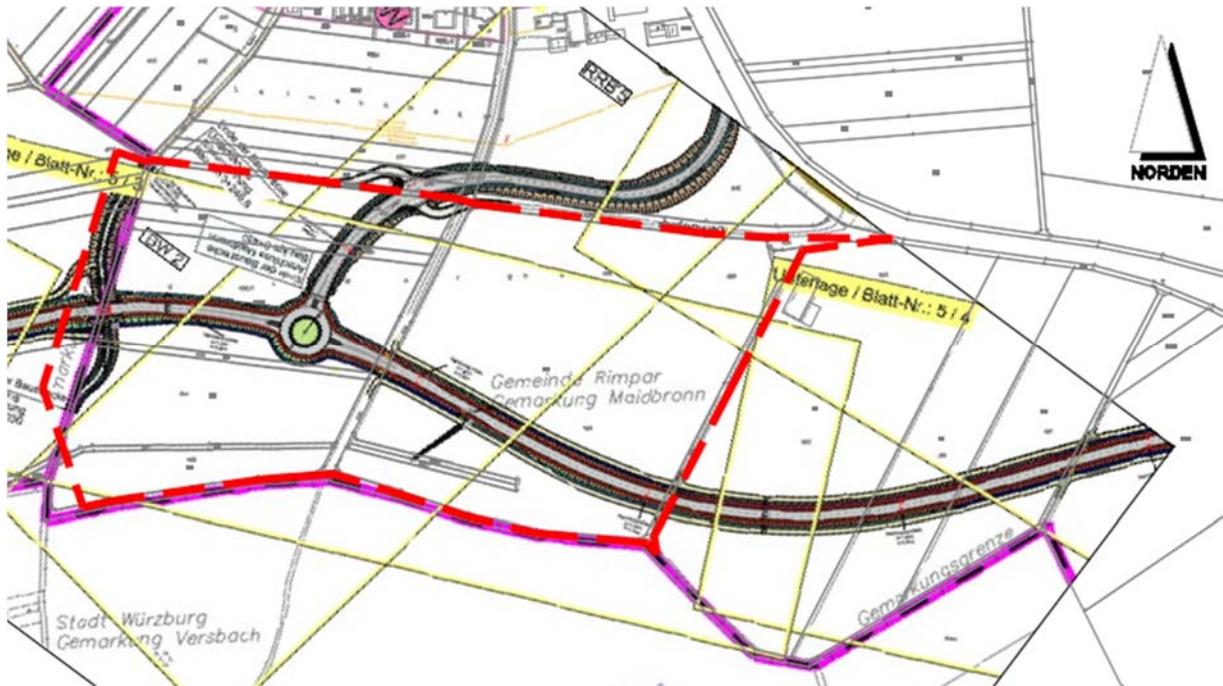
Auszug Übersichtslageplan Vorentwurf Ingenieurgesellschaft Maier Neubau Südumfahrung mit Geltungsbereich der 11. Änderung
